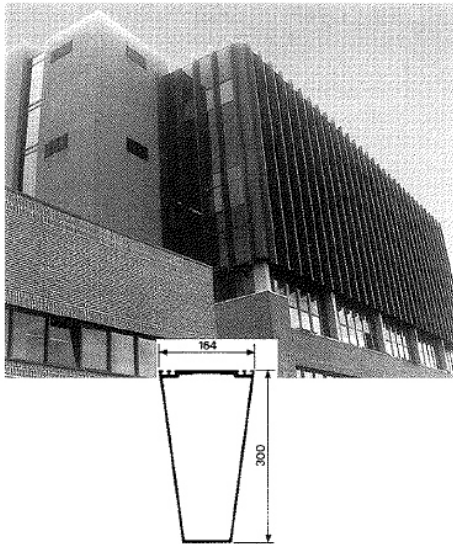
Fachada de aluminio de la oficina postal en Odense, Dinamarca, con la sección usada para soporte vertical.
